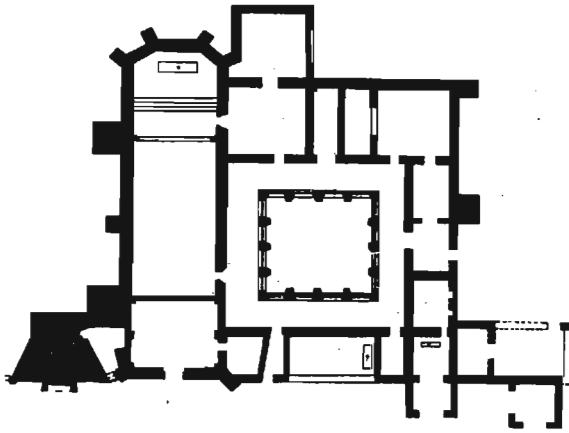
Planta del convento de Atlatlahucan de 1570 con la capilla aislada al norte del templo.
